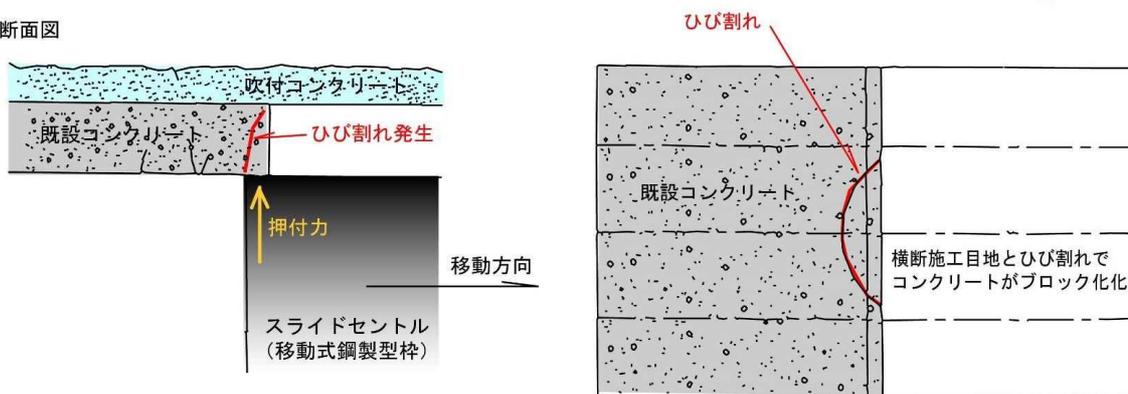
覆工打設時におけるひび割れ発生モデル
